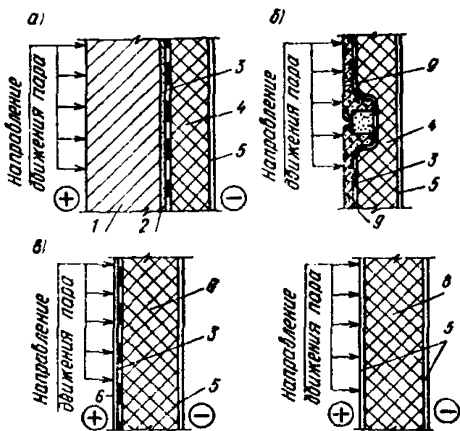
Схемы тепло-пароизоляции стен и перегородок
